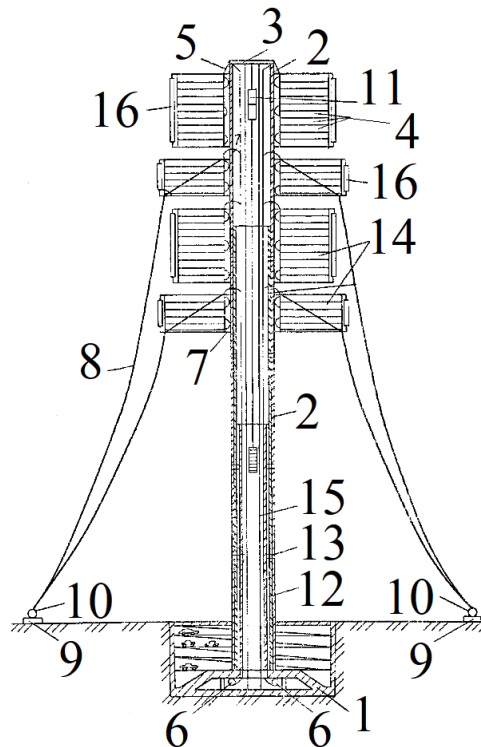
Подвесное здание повышенной этажности: 1 – фундамент; 2 – несущий ствол; 3 – оголовок; 4 – этажные конструкции; 5 – подвески; 6 – механизмы подъёма; 7 – катки; 8 – оттяжки; 9 – опоры; 10 – лебёдки; 11 – лифты; 12 – шкивы; 13 – стяжные болты; 14 – этажные блоки; 15 – тросы; 16 – лопасти
